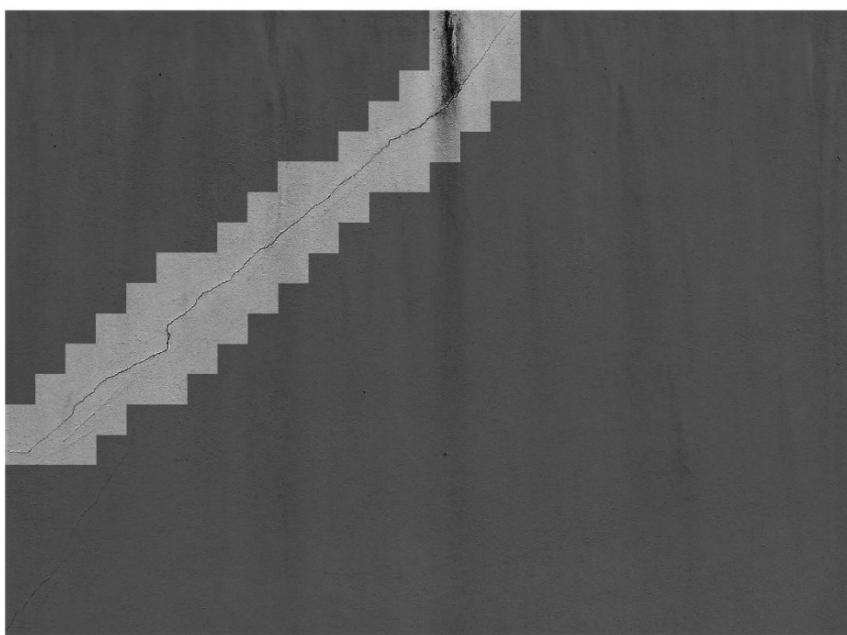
Deteção Fissura Z.F.01
